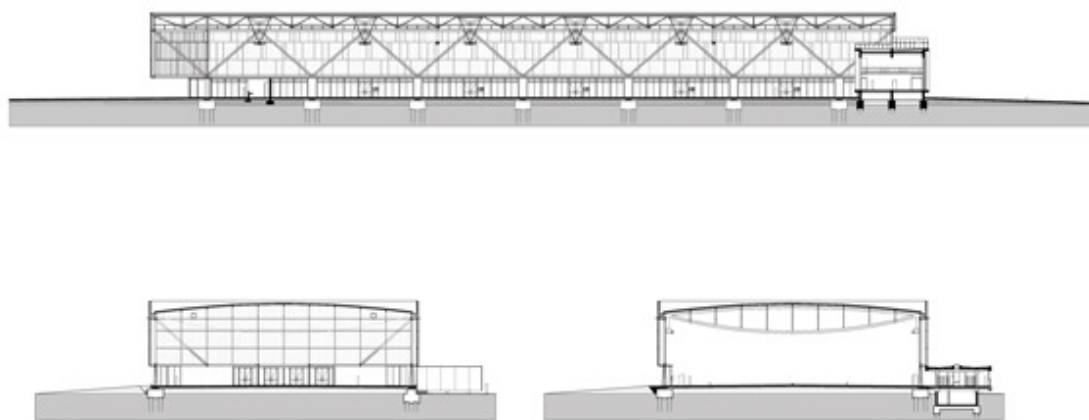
Corte longitudinal e transversal do projeto do Pavilhão Tortosa.
